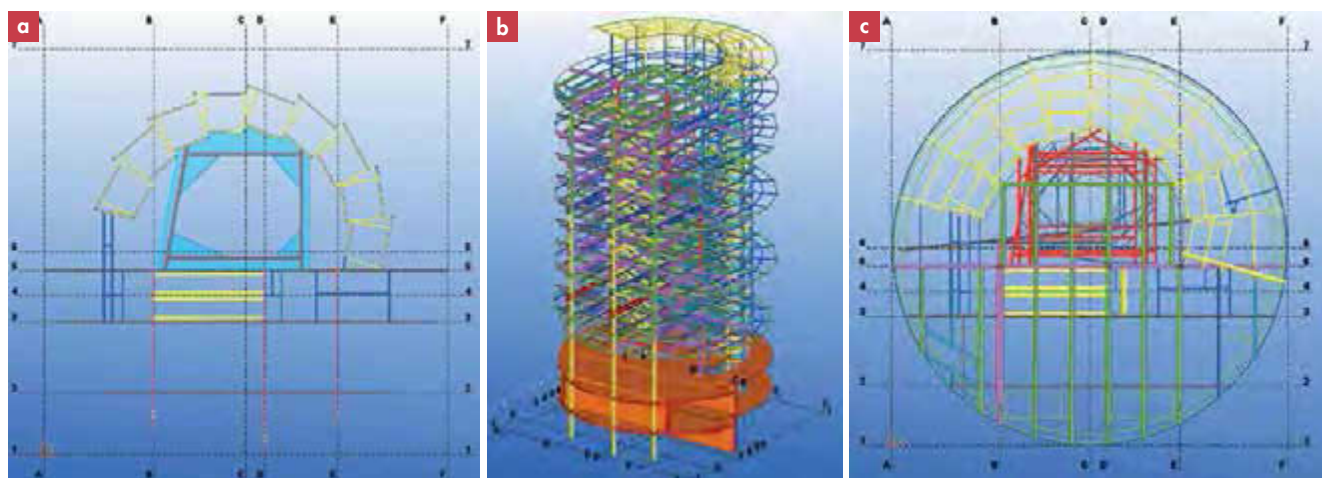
a) Primera planta. b) 3D. c) Vista de planta.
